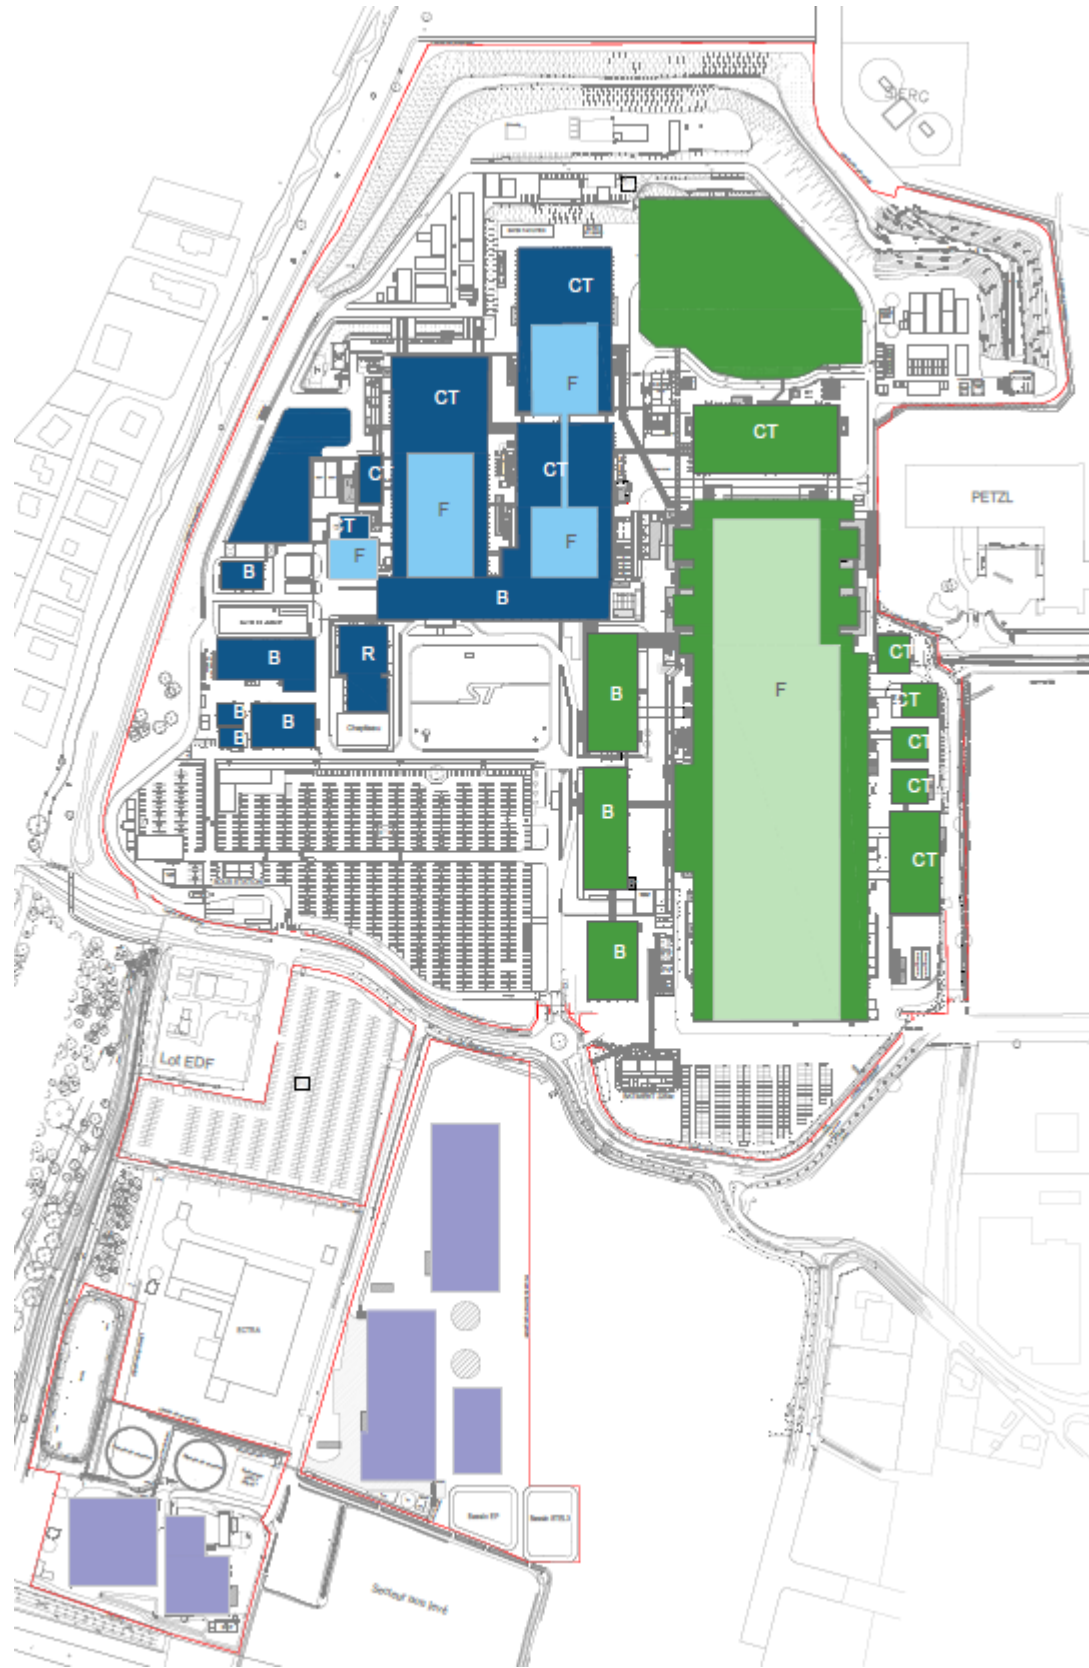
PLAN DU SITE DANS SA CONFIGURATION FUTURE DEFINITIVE
